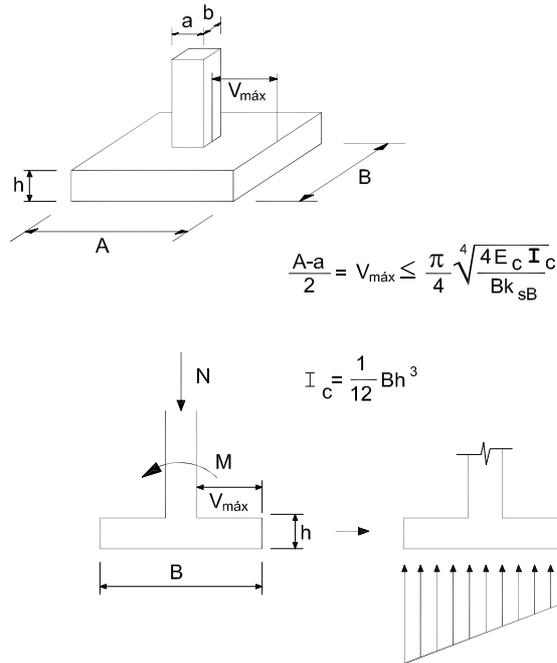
Criterio de rigidez relativa para zapatas aisladas
